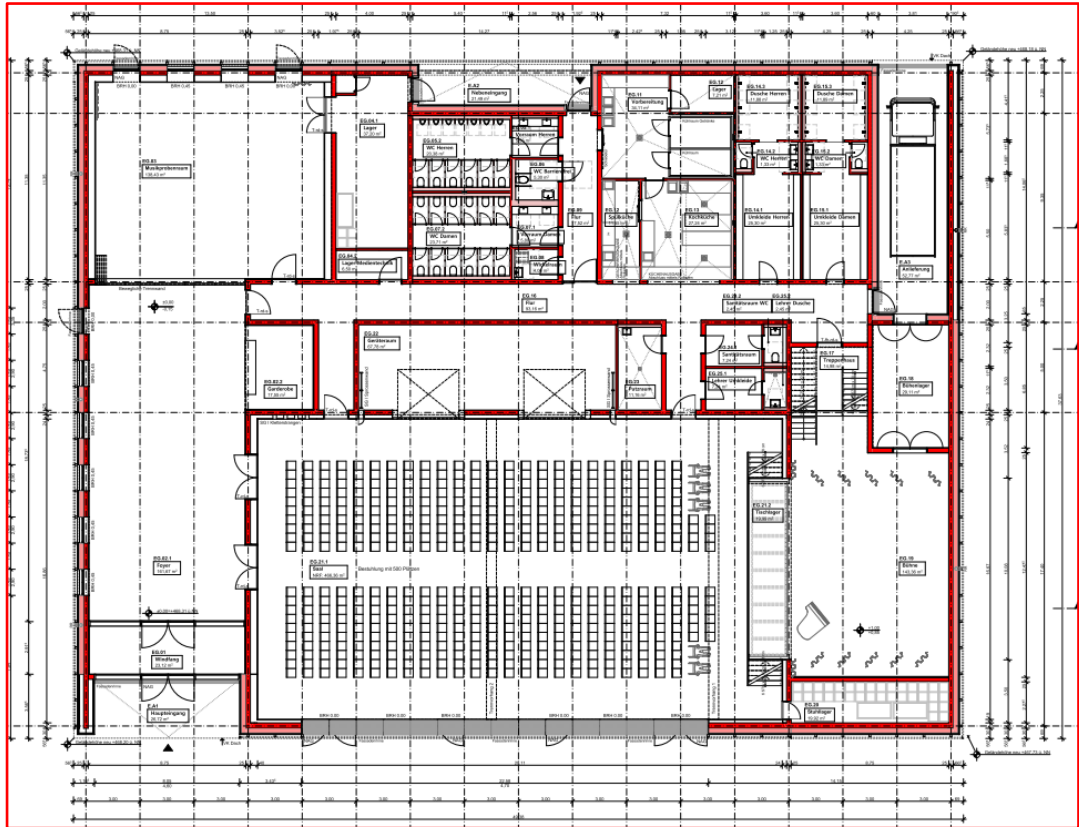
Erdgeschoss Lageplan, Neubau Ludwig-Uhland-Halle Gärtringen, Drei Architekten, Stuttgart, ~~27.06.2022~~ 17.03.2023, Bauantrag (~~Vorabzug~~)
